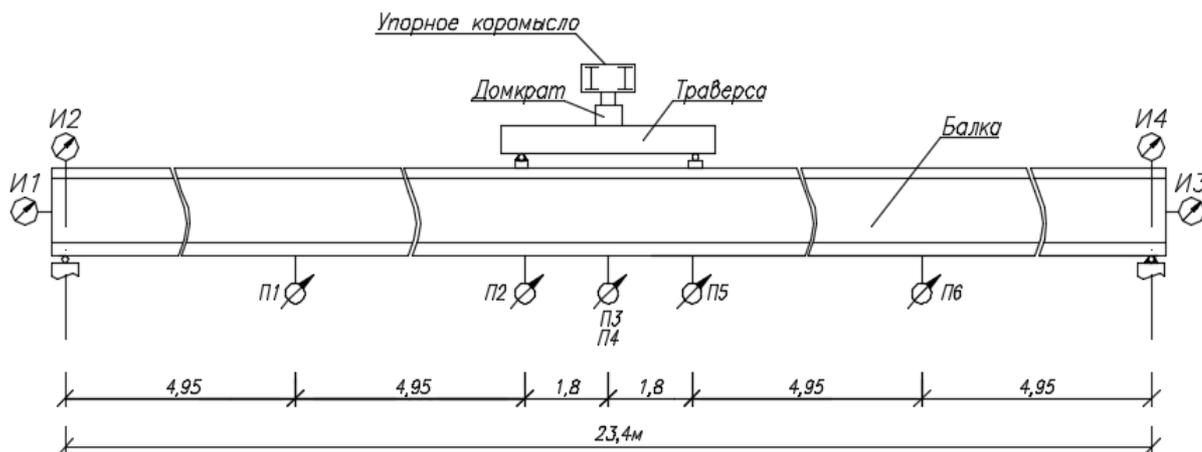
Расчетная схема испытаний балки ВТК-24у
